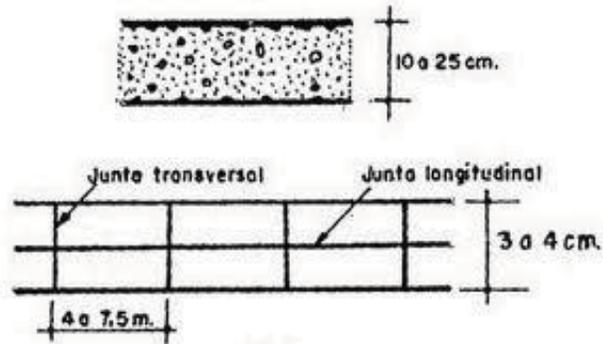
Estructura de un pavimento de concreto hidráulico simple.
